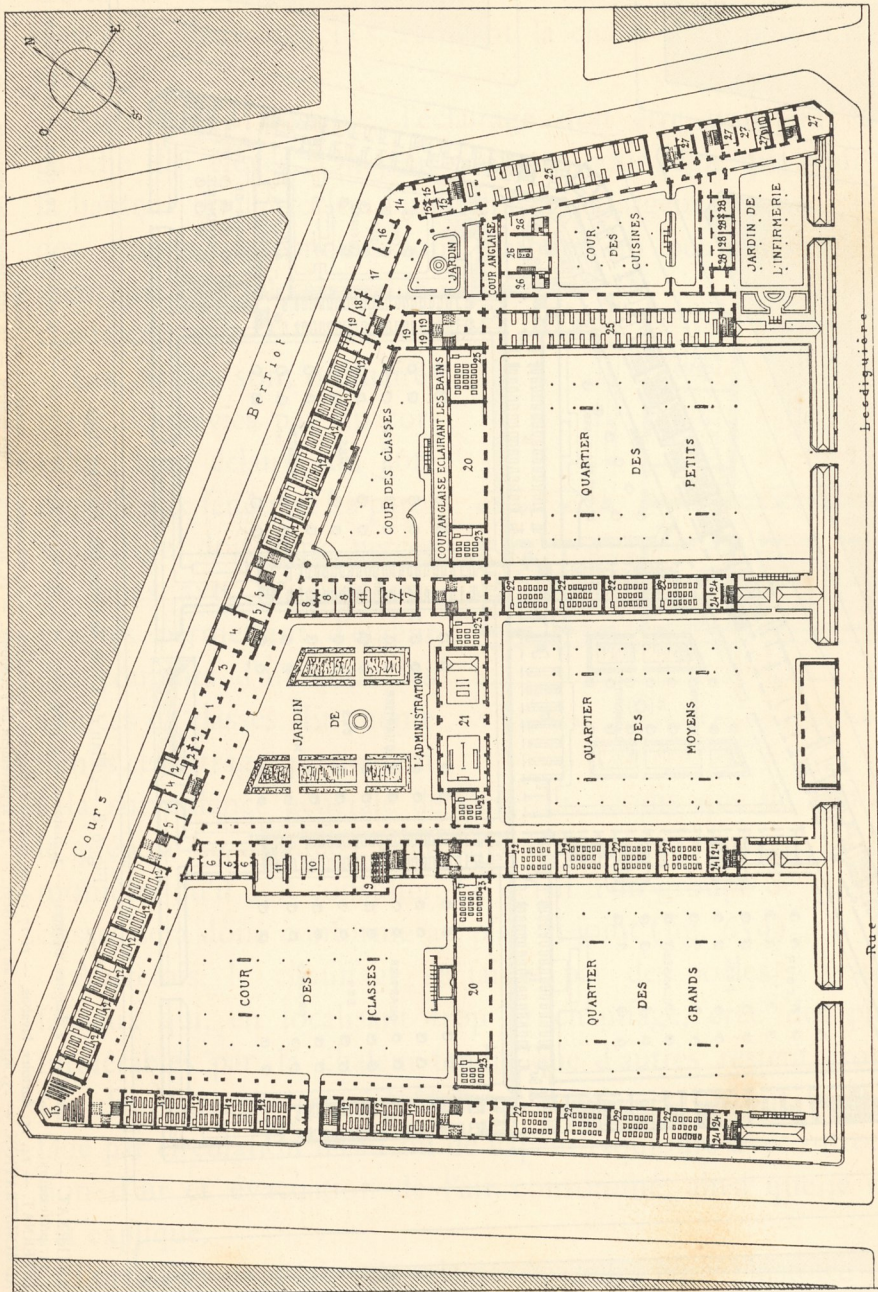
Plan du Lycée de Grenoble. Rez-de-chaussée.
